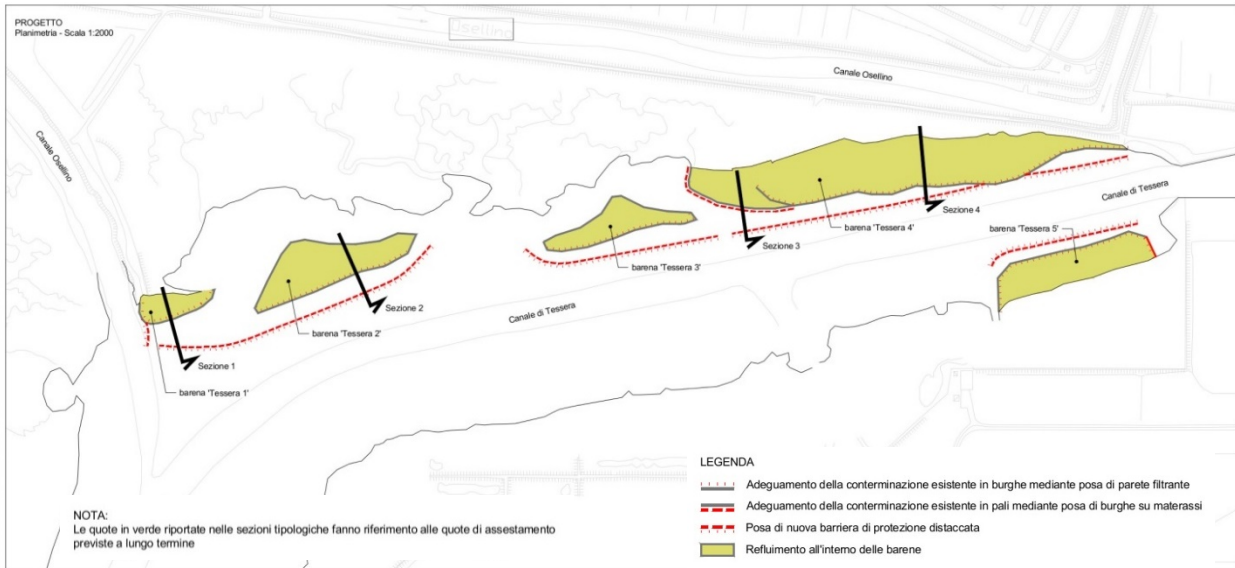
Planimetria e sezioni tipologiche degli interventi.
